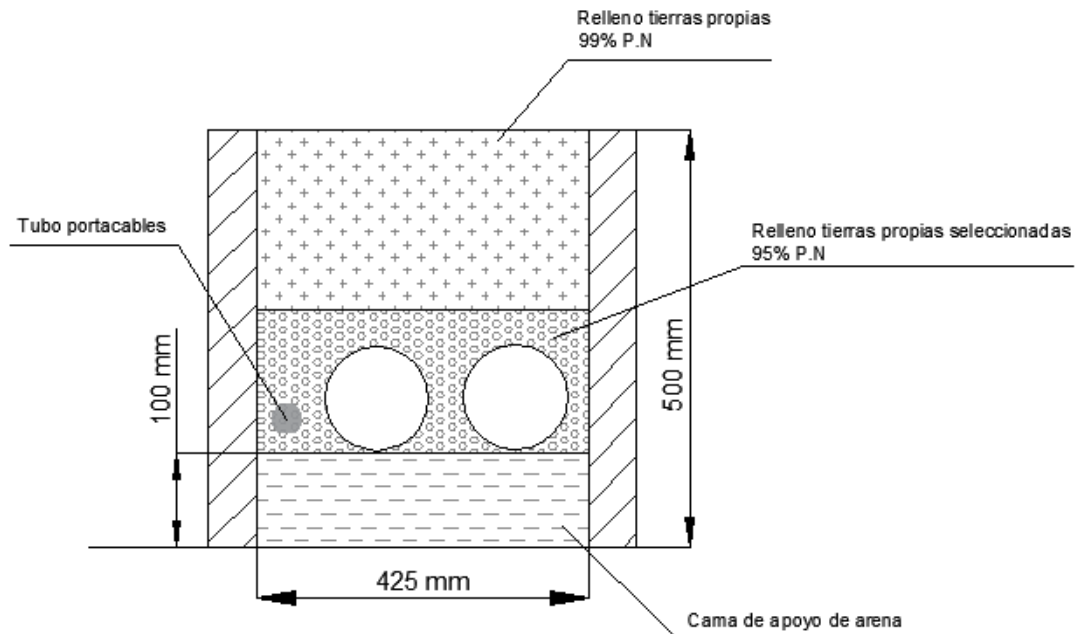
Dimensiones zanja para el caso de dos tuberías y el tubo portacables
